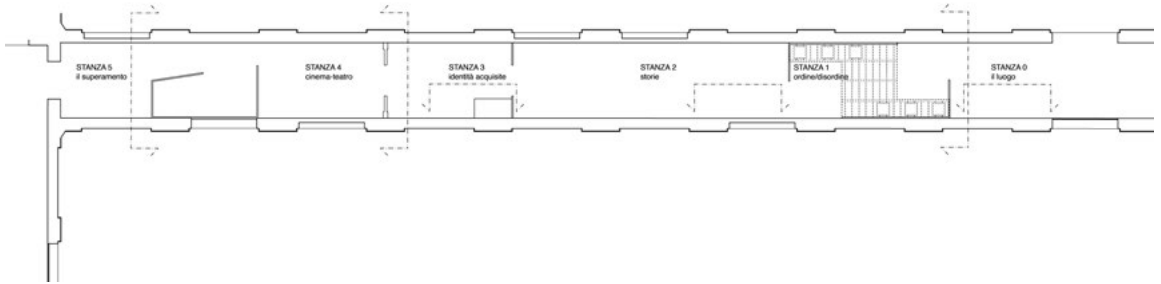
Pianta con l'indicazione delle linee di sezione sugli allestimenti. Elaborato di E. Martinelli, 2021.
